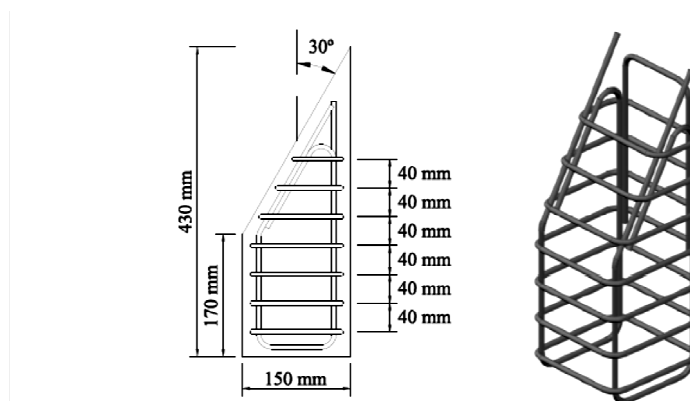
Esquema da armadura utilizada (Santos e Júlio, 2011).
